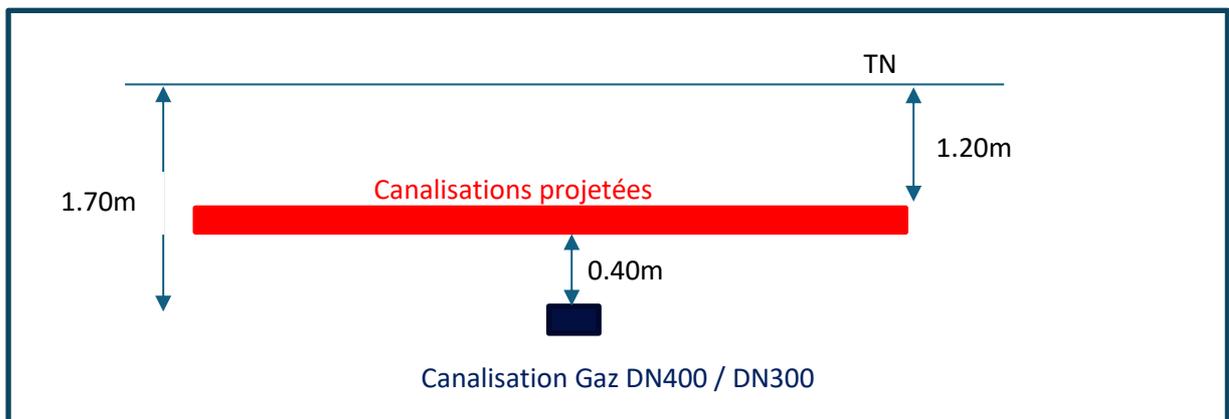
Coupe type au droit du croisement avec les réseaux de transports gaz
